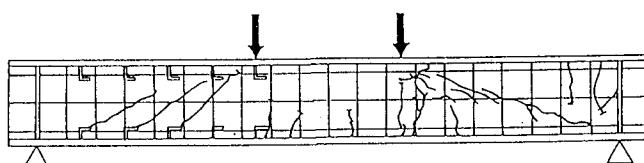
コンクリートのひびわれ観察図 (Case3)
